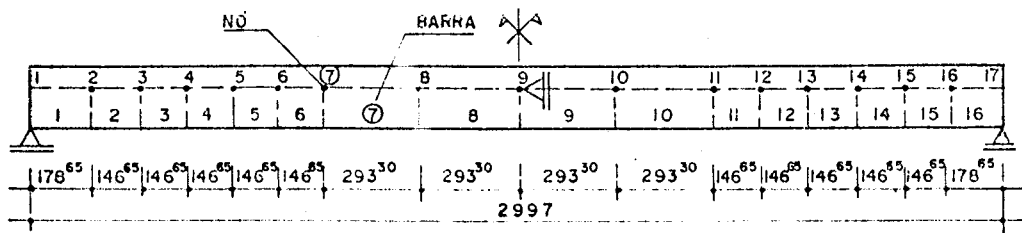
DISCRETIZAÇÃO DA ESTRUTURA.
